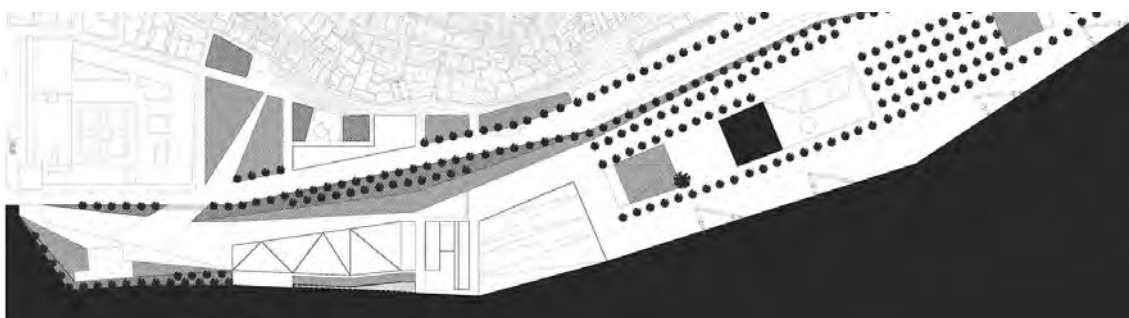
Desenho em planta, pormenor das alterações da faixa costeira. (Ilustração nossa, 2011)
